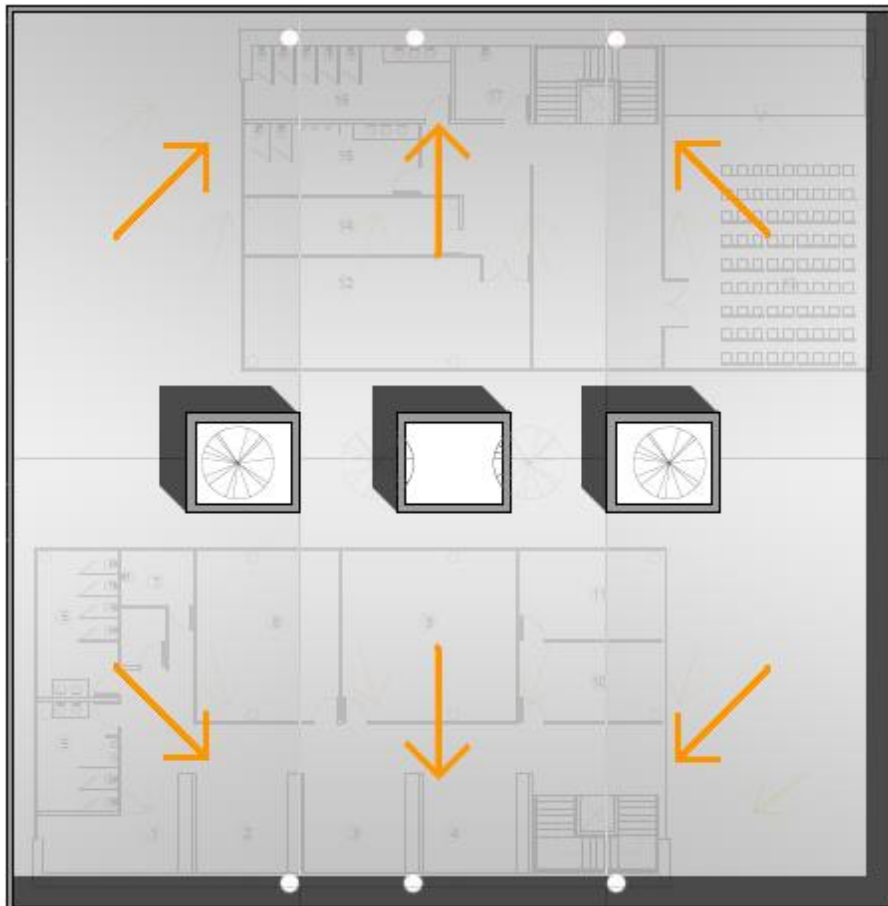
Cubierta, vista en planta. Fuente: autoría propia
